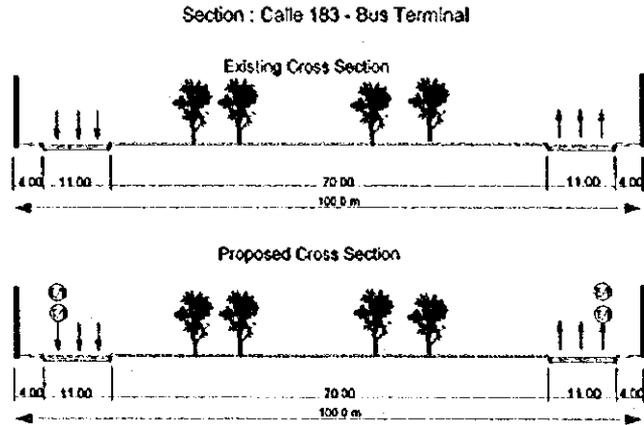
Sección Típica sobre Autopista Norte (1)
